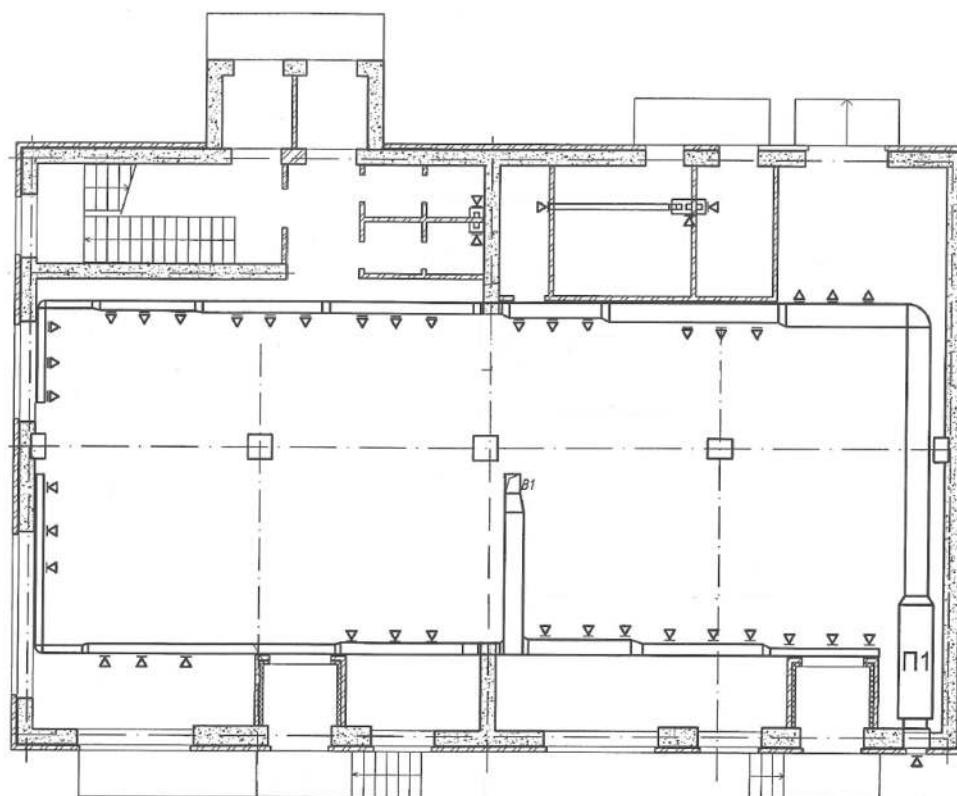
Существующая схема вентиляции первого этажа
